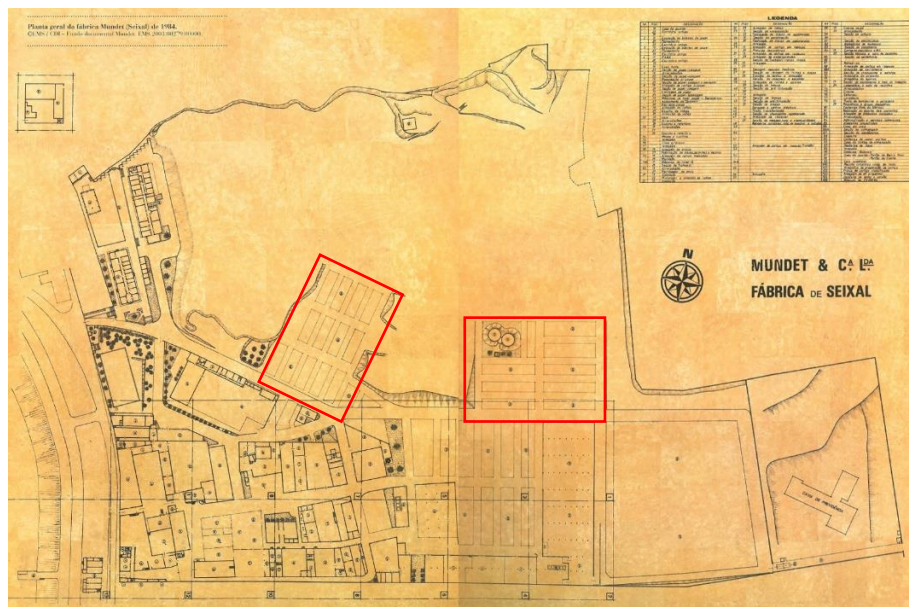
Planta Geral da fábrica Mundet (Seixal) de 1984. Fonte: (Filipe et al. 2010)
